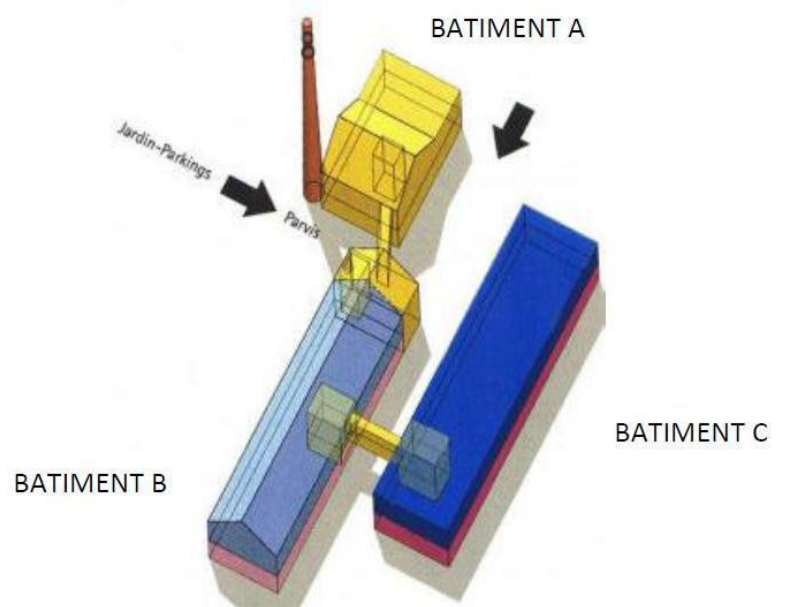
plan des bâtiments, coll. J.-J. Cachau
